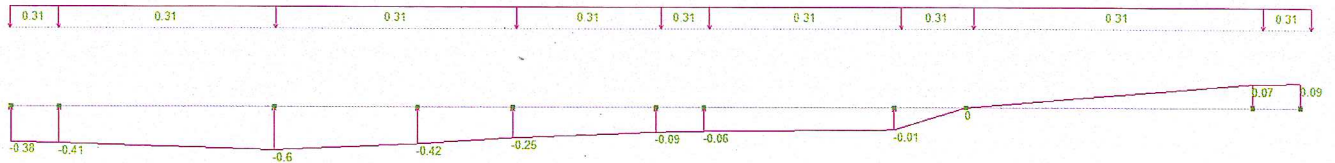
Схема приложения нагрузка на балку: а – нагрузка от собственного веса кровли, б – ветровая нагрузка
